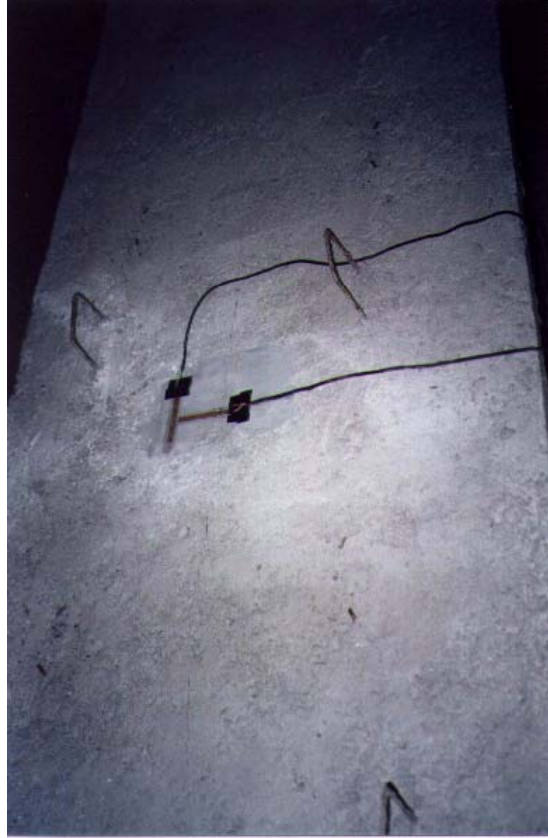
Posicionamento dos EER na laje de concreto (modelos 4 e 6)
